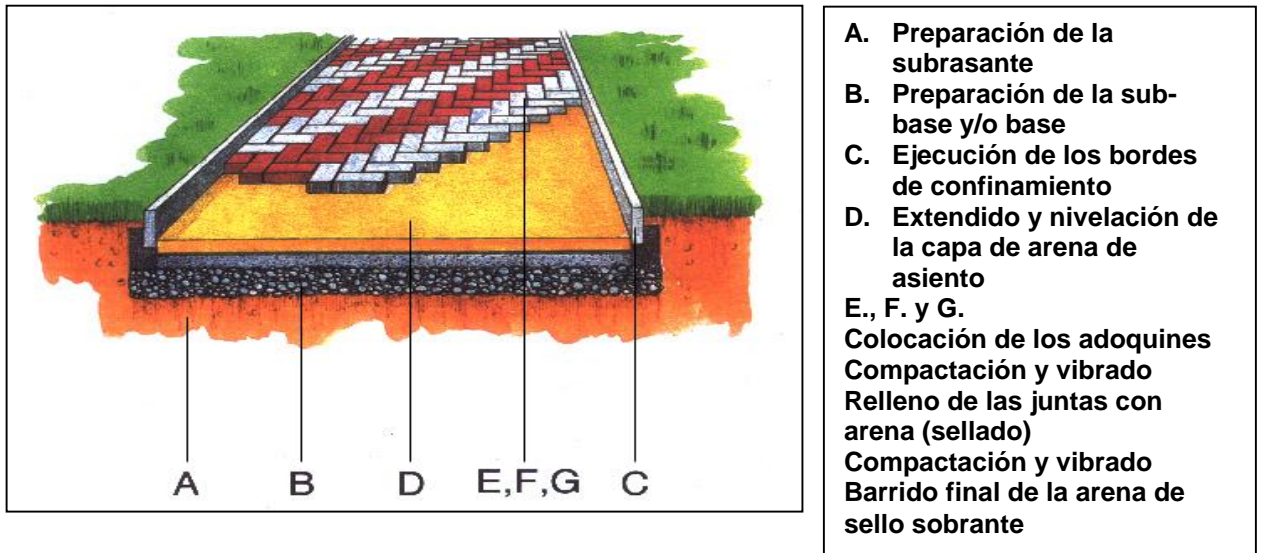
Proceso Constructivo de un Pavimento Intertrabado
